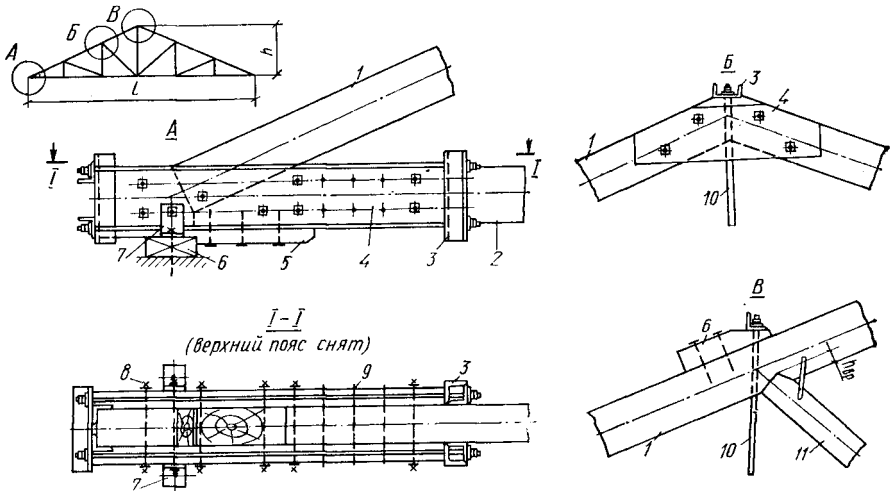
Брусчатая треугольная ферма на лобовых врубках:
